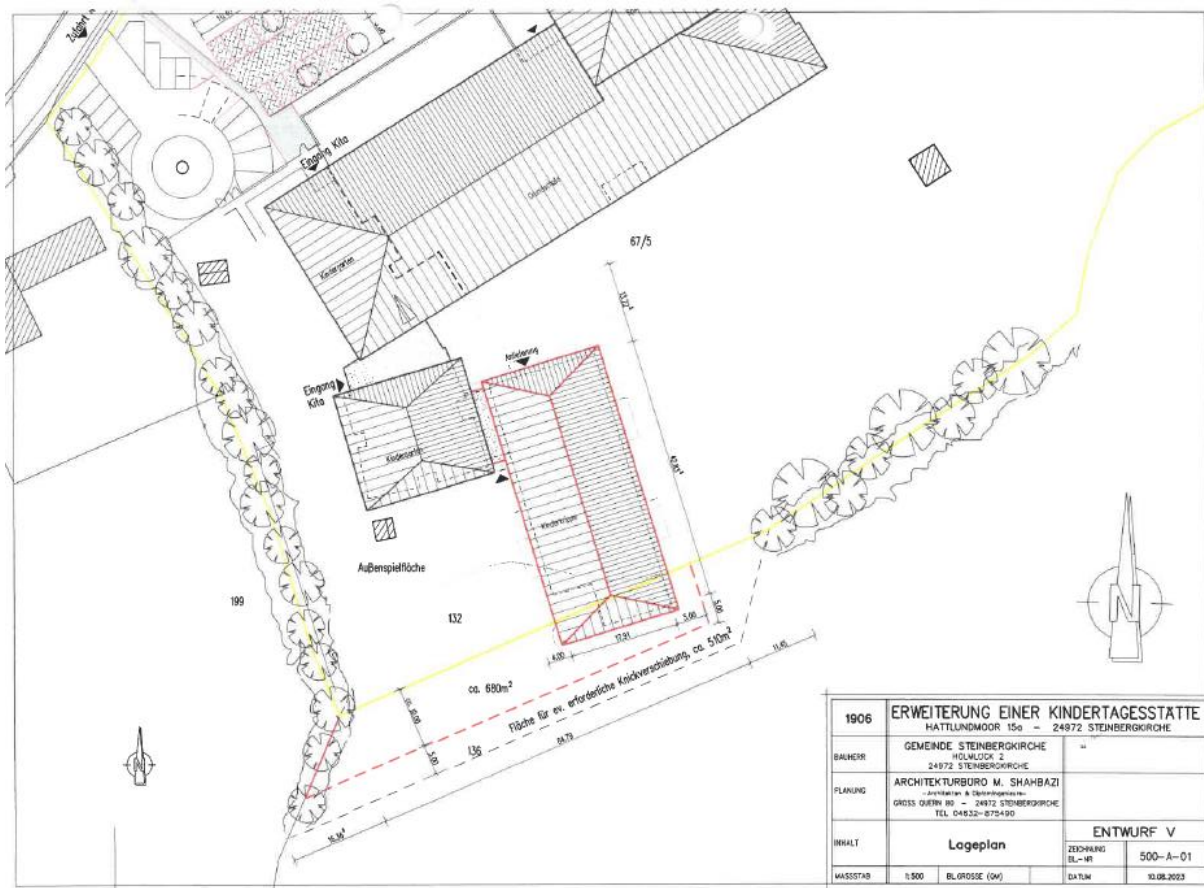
Lageplan der KiTa „Siebenstern“ (rot: geplante Erweiterung) (Quelle: Shahbazi Architekten)
